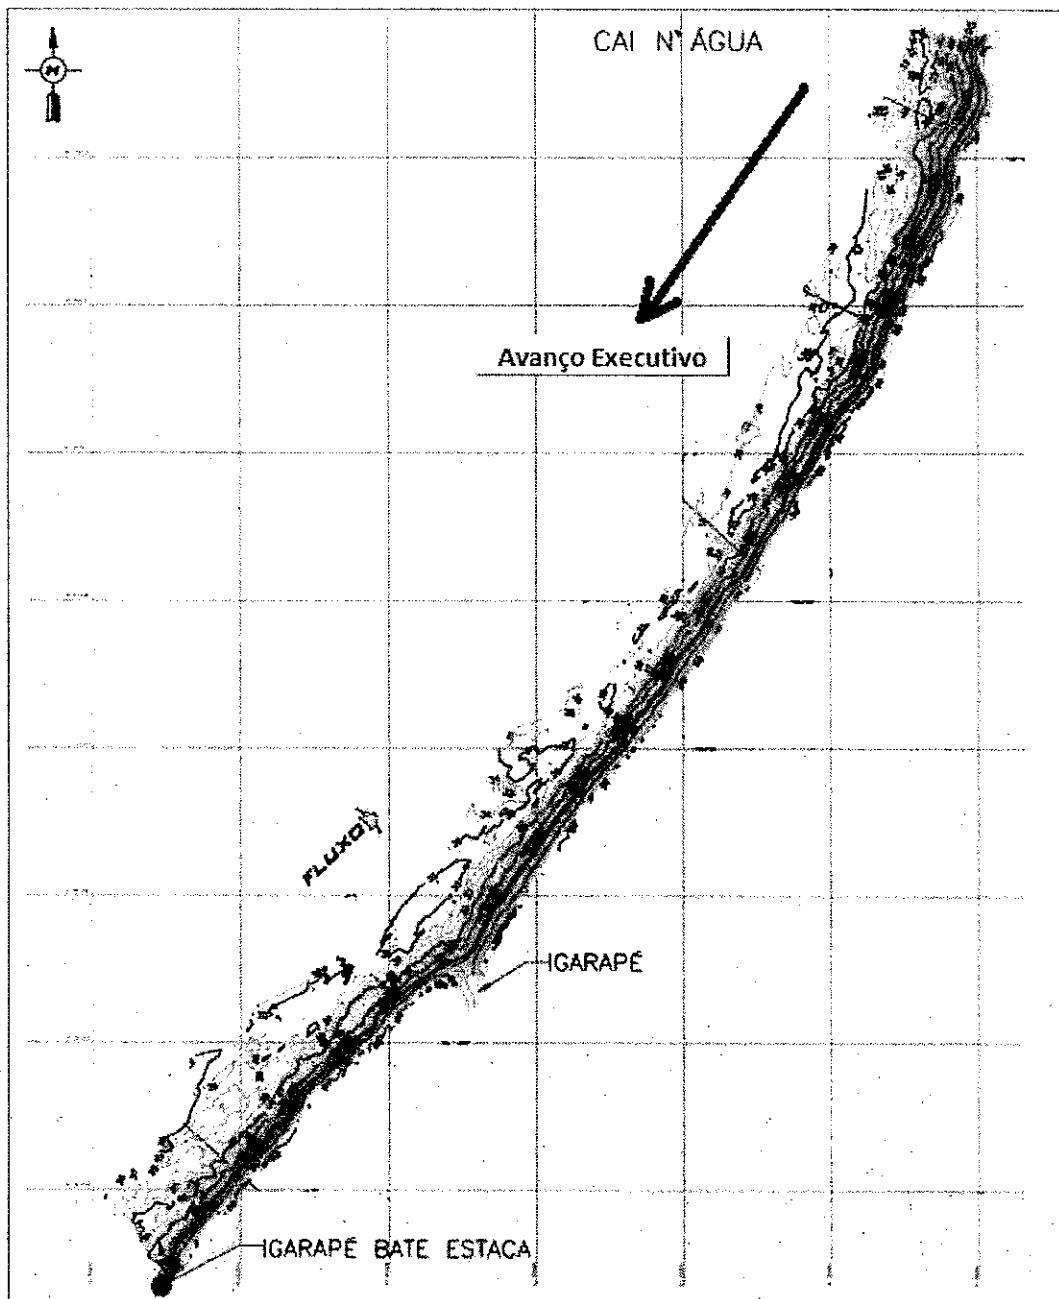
Planta Baixa – Sentido do Avanço Executivo Adotado.
